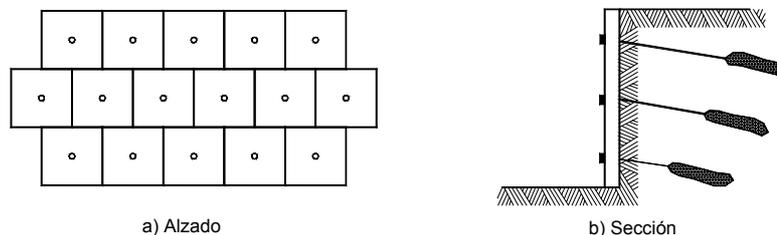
Muro de hormigón armado, anclado, efectuado por bataches
